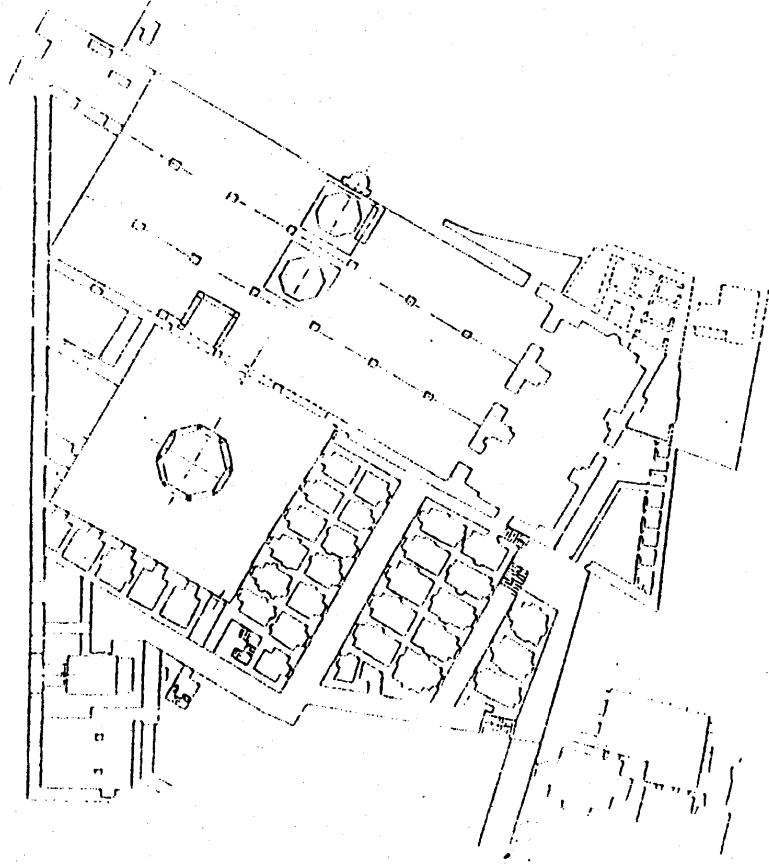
مسقط أفقي لمدرسة أيتمشن البجاسي بالقاهرة (عن : صالح لمعى) .
